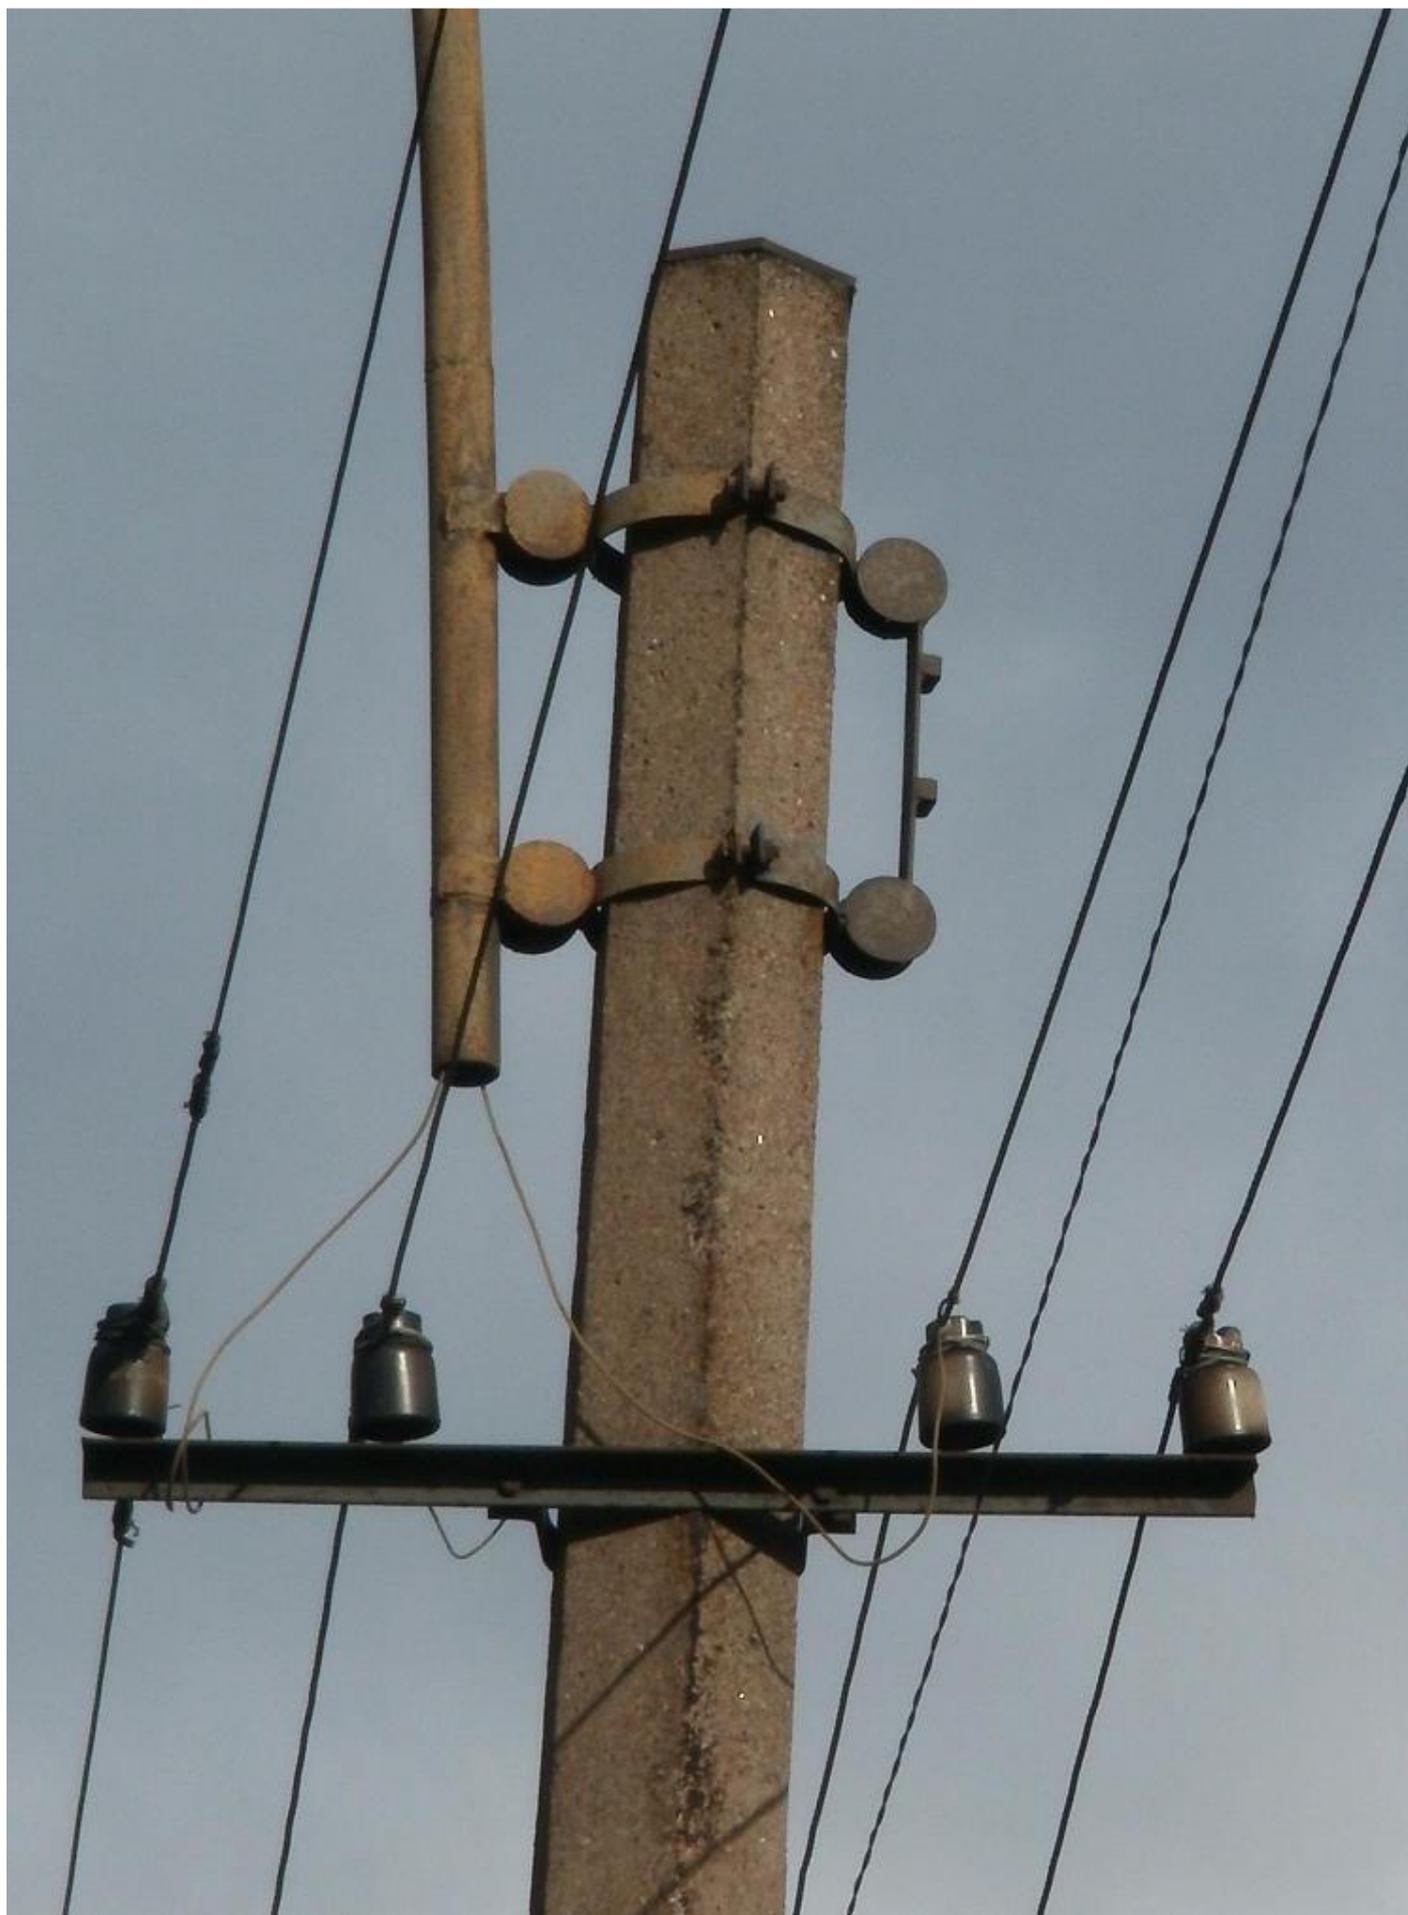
Узел крепления консоли версии 1 к столбу. Крупный план без ящика.
